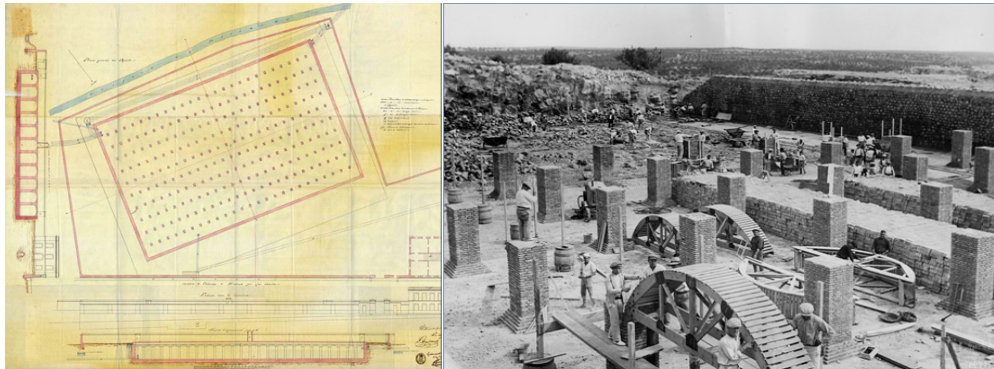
Fotografías de los planos de ejecución y construcción del edificio (Fuente: MHV).
